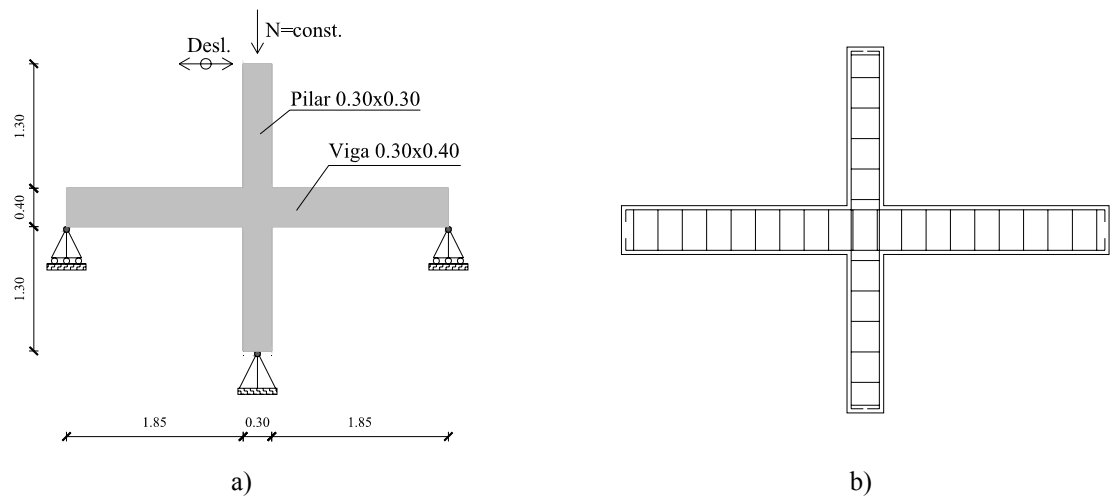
Esquema dos provetes dos nós viga-pilar: a) esquema de ensaio; b) disposição da armadura
